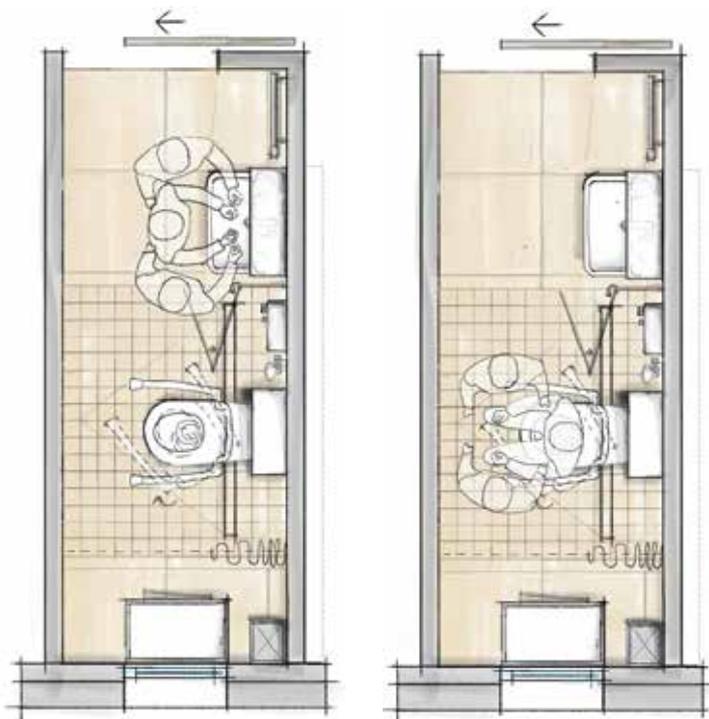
Umbauvariante 8 – Schlauchbad mit Assistenz an Waschtisch und Toilette (Grundriss: DLW)
